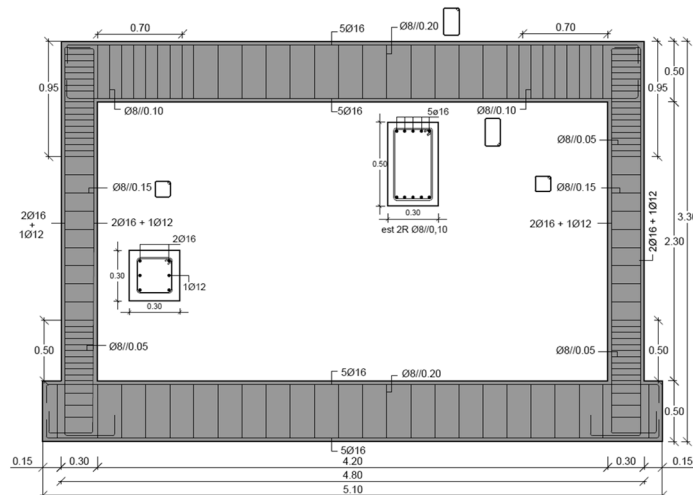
Dimensões geométricas do pórtico de betão armado com parede de enchimento (unidades em metros).
